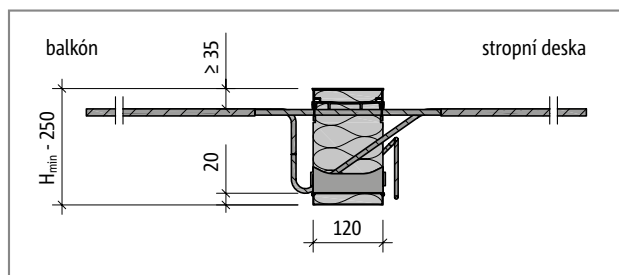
Schöck Isokorb® typ KXT50: Půdorys prvku
